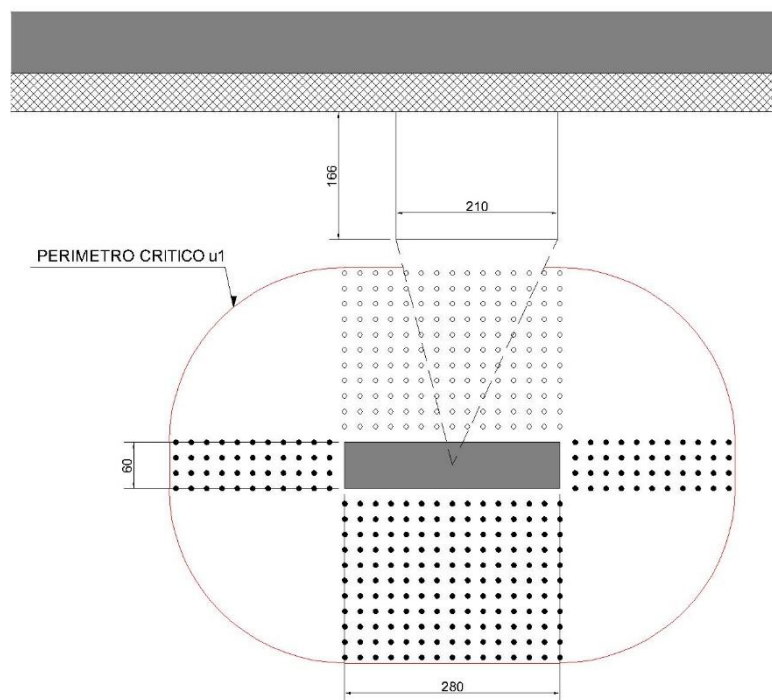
Diaframma interno con individuazione del perimetro critico - Pianta
